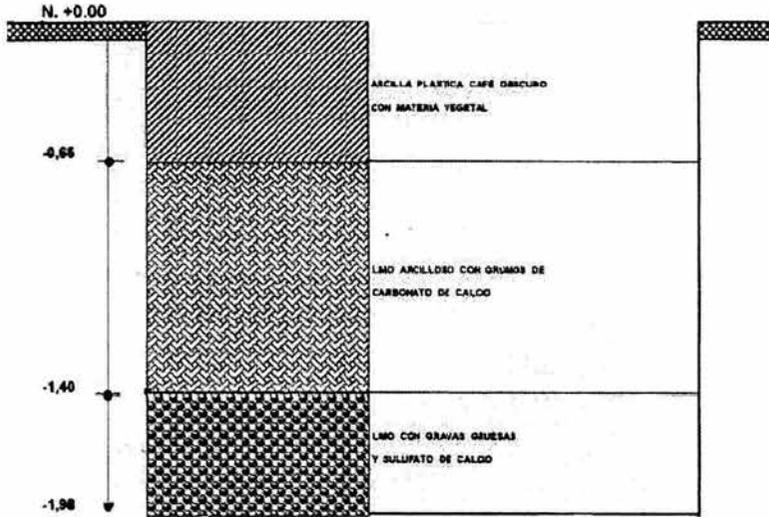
PERFIL ESTRATIGRÁFICO POZO A CIELO ABIERTO-1
